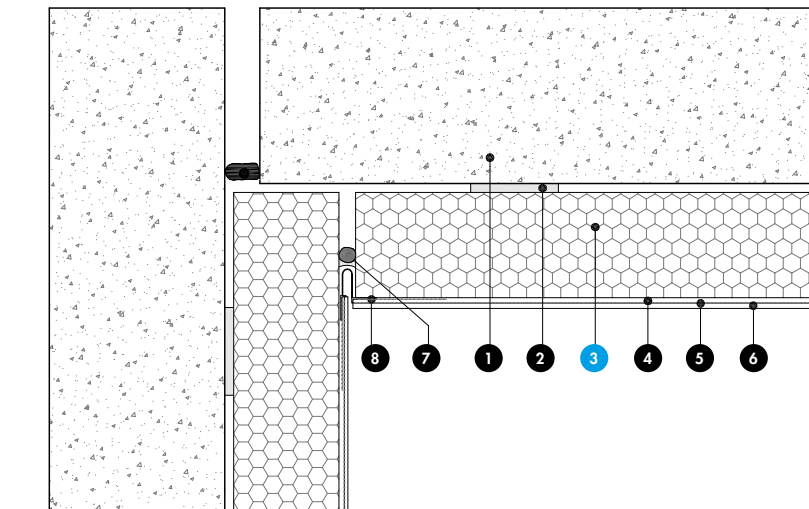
Joint de dilatation : angle rentrant (coupe horizontale)
